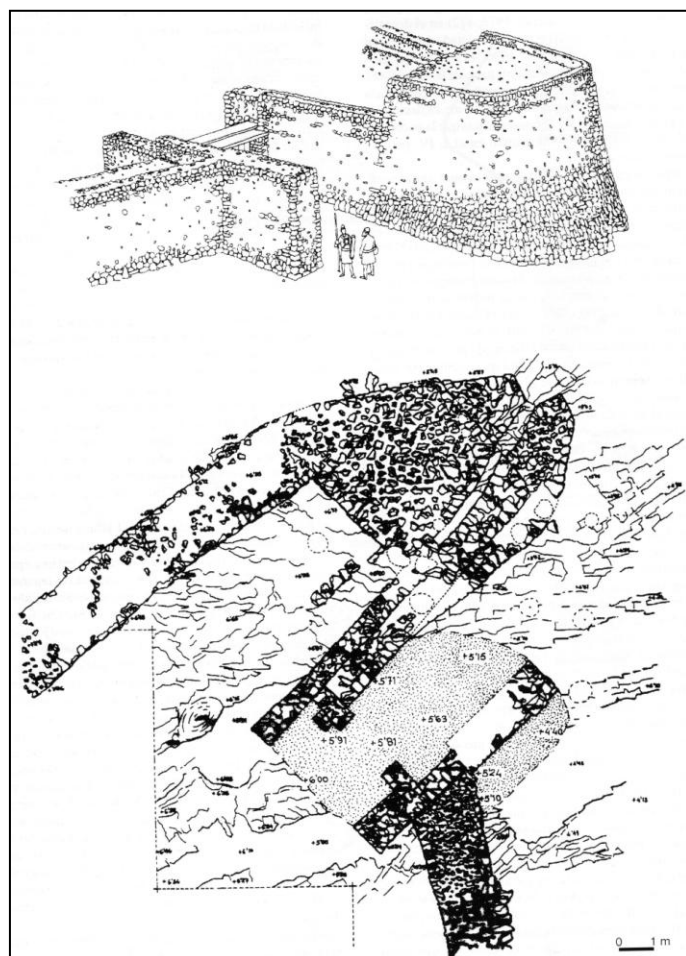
Planimetría y reconstrucción hipotética de la puerta de La Serreta.
